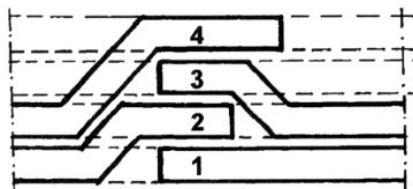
Zakład czołowy dachówek cementowych. [www.euronit.pl].
